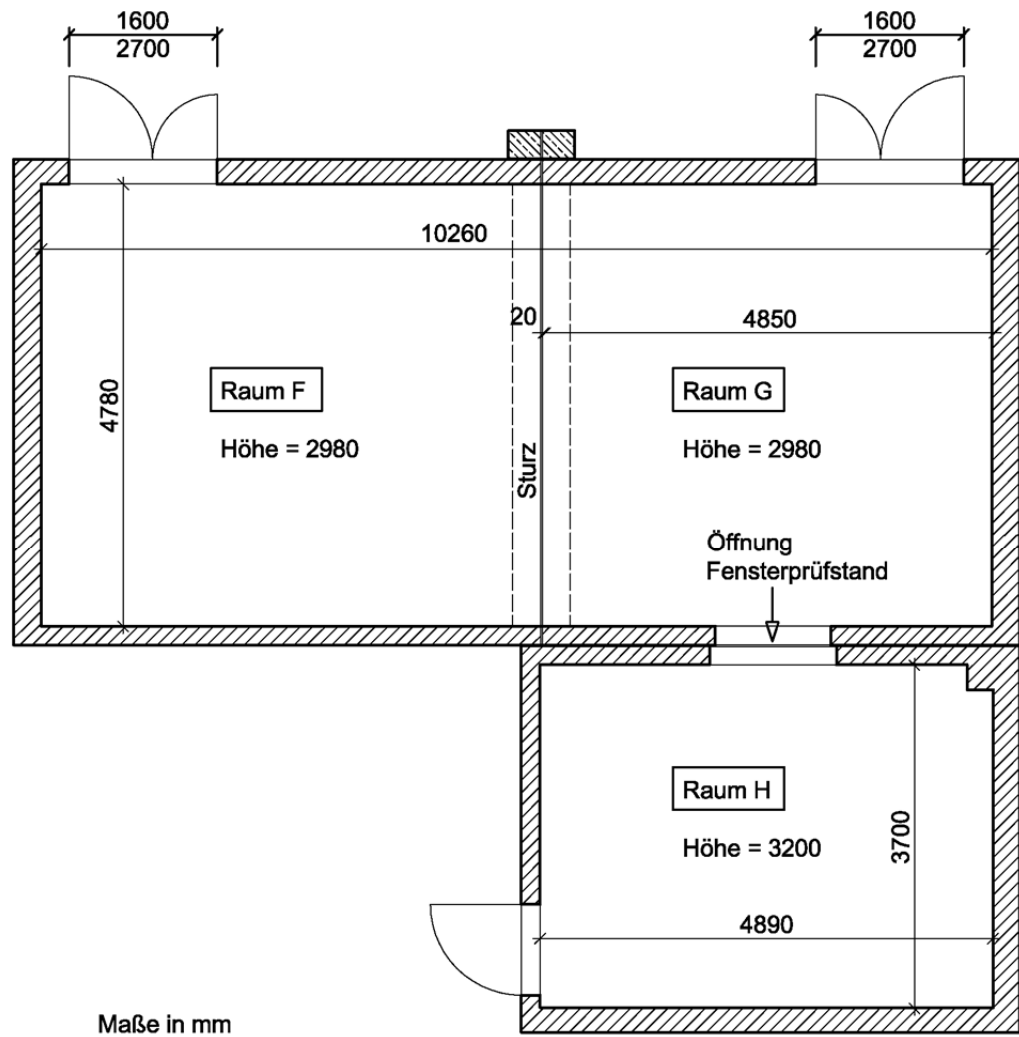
Grundriss des Fensterprüfstands.
